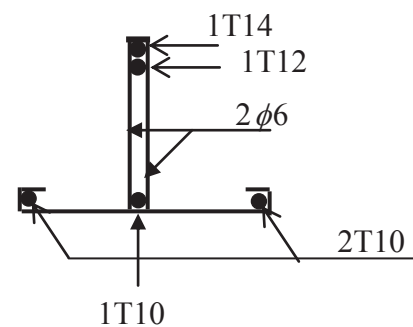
Schéma de ferrailage des poutrelles types 2, 3, 4 et 5 du 1^{er} étage
